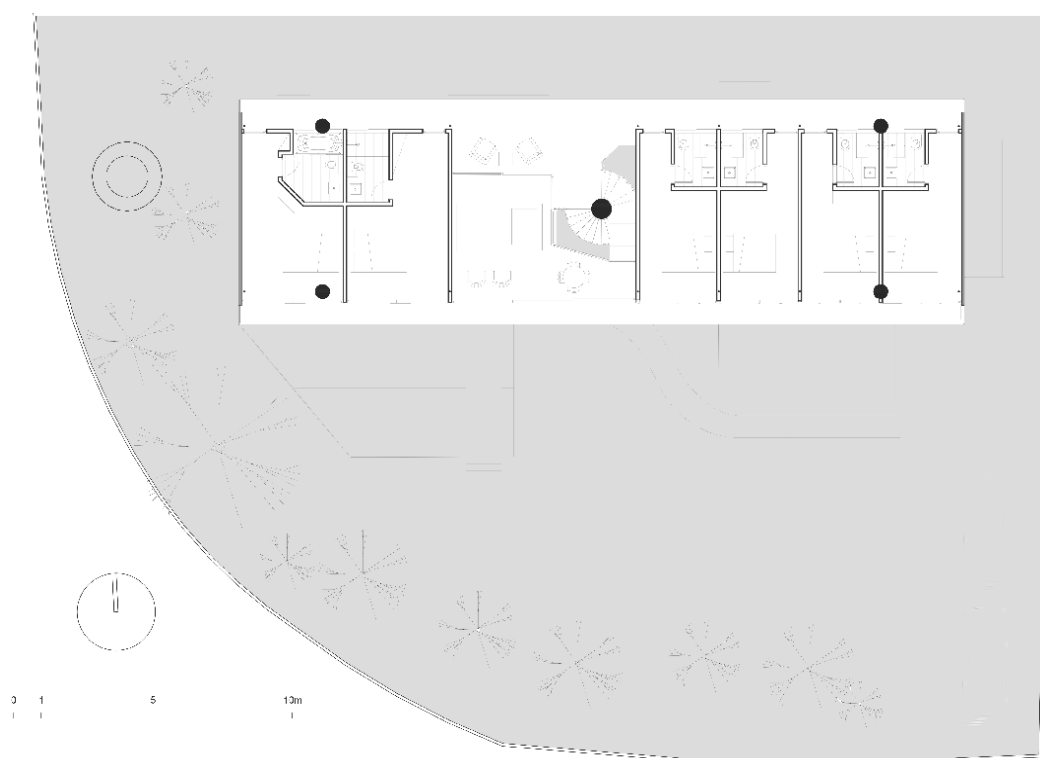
Planta do 1º pavimento. Fonte: AUTOR (2017).
